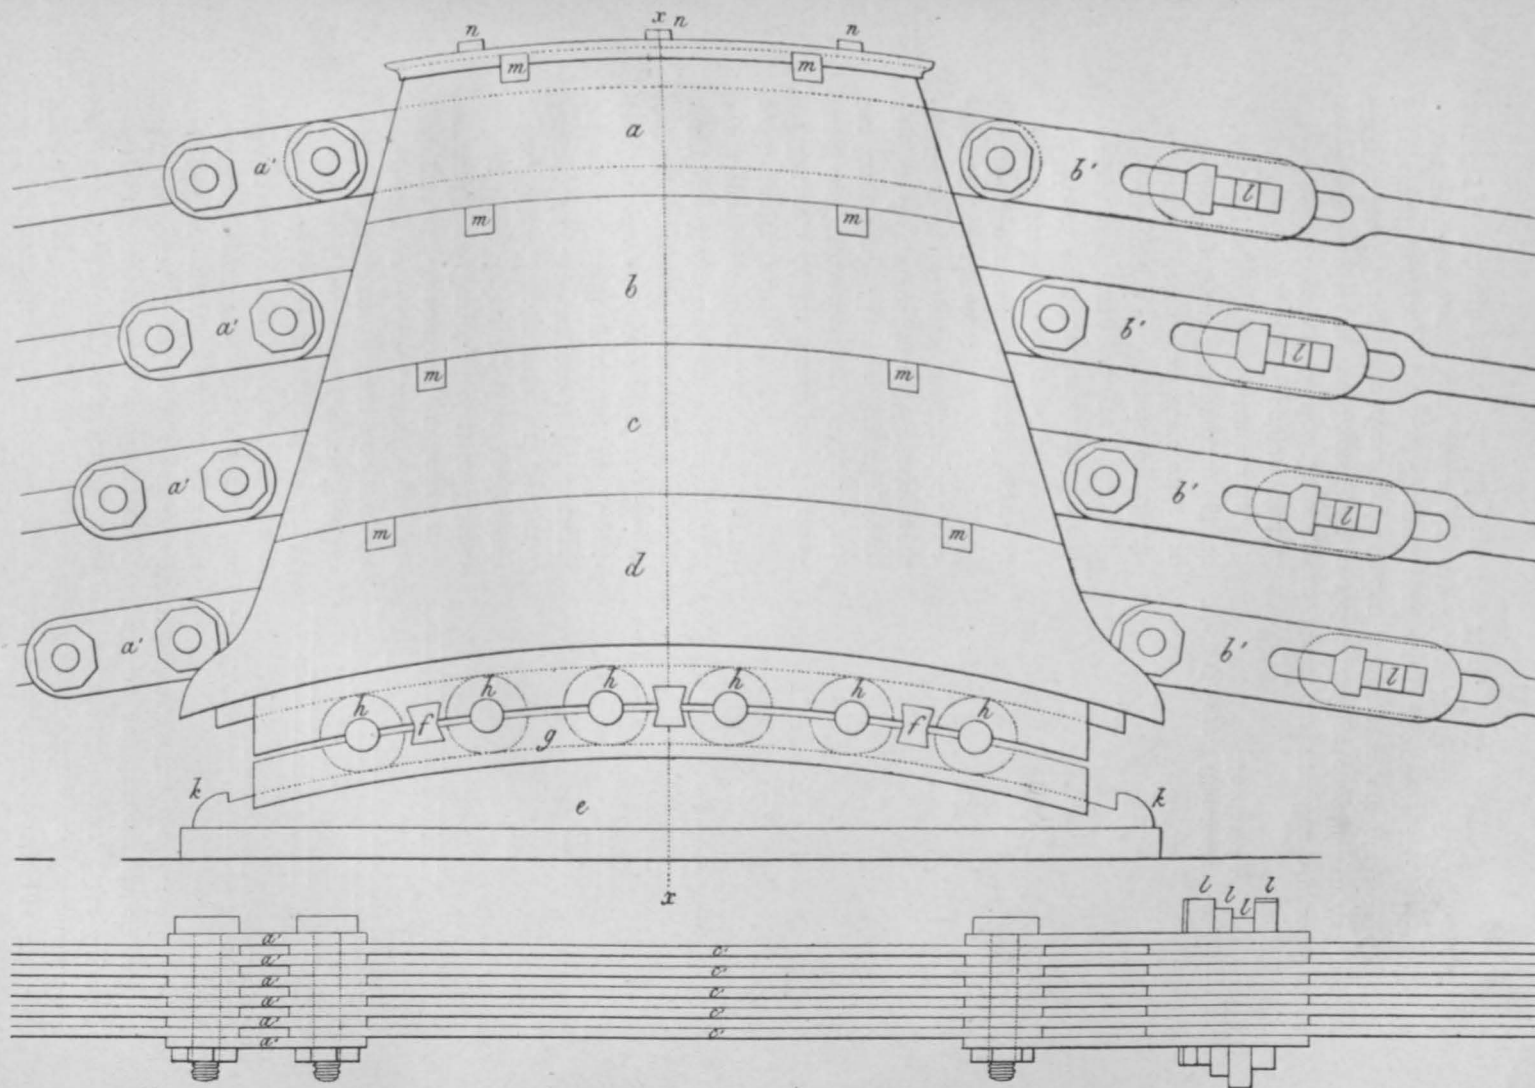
Lagerung der Ketten der Menaibridge über den Mittelpfeilern.
